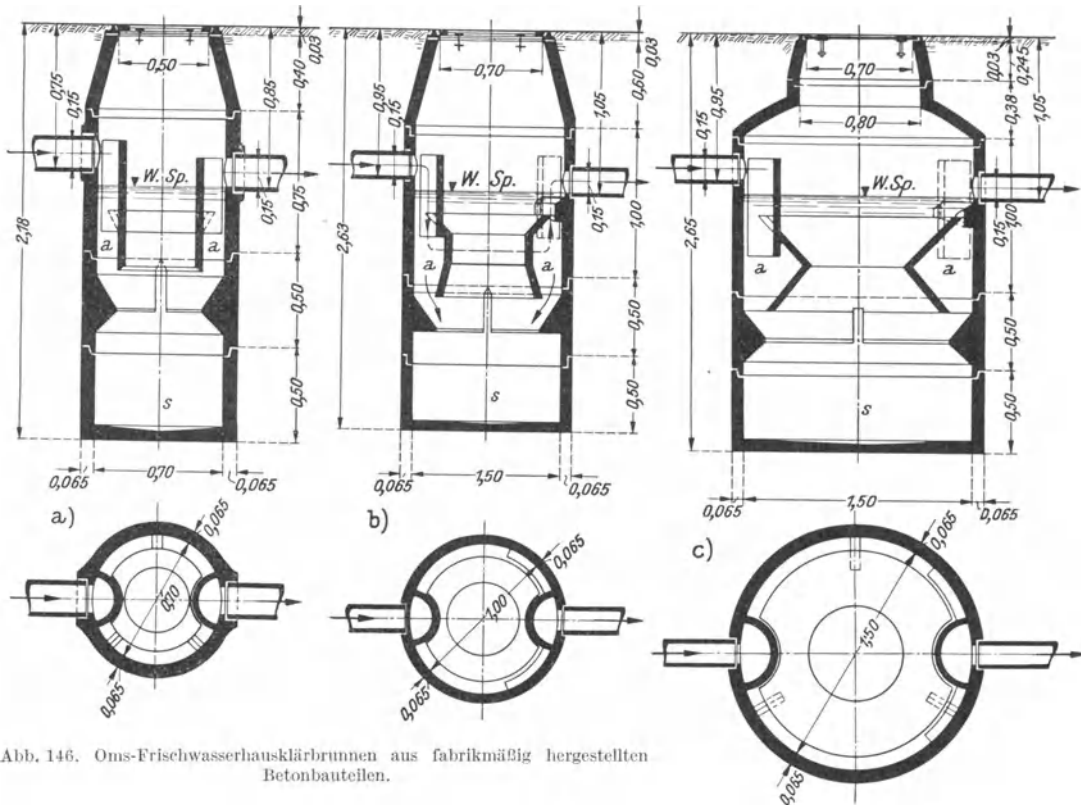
Oms-Frischwasserhausklärbrunnen aus fabrikmäßig hergestellten Betonbauteilen.
